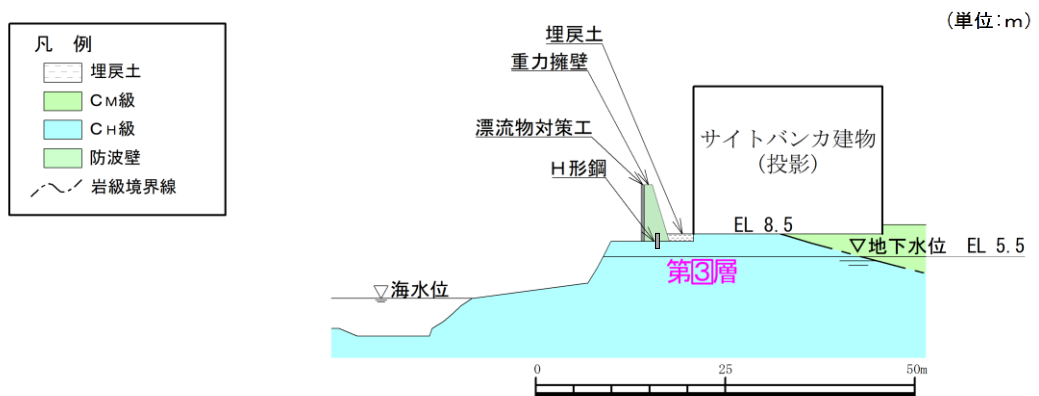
地質断面図 (⑤-⑤断面)
